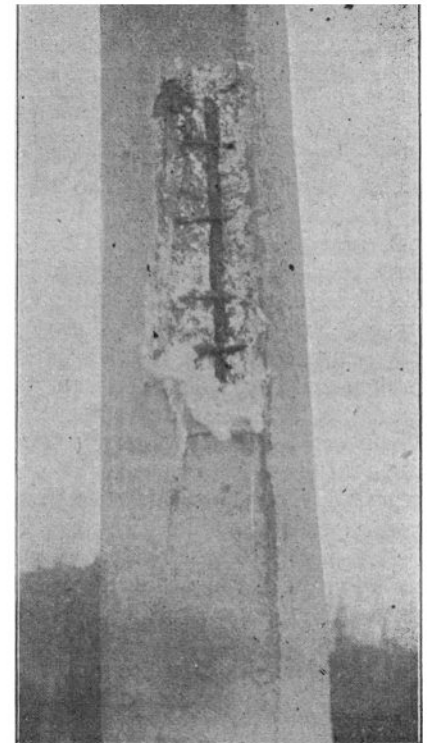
Eisenbetonmast mit Längsrissen. Freigelegte Eiseneinlage stark angerostet. Aufgestellt 1910.
